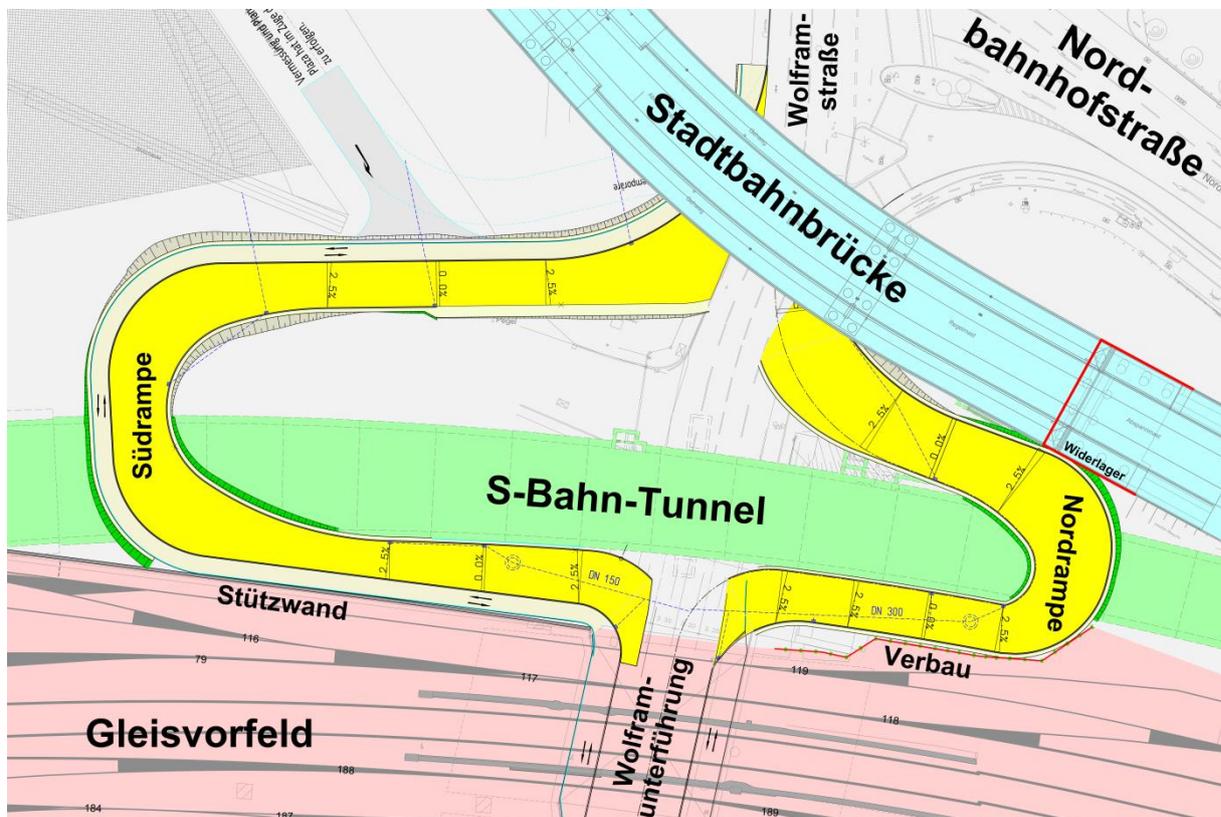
Übersicht - geplante Umfahrungsschleifen Wolframstraße
